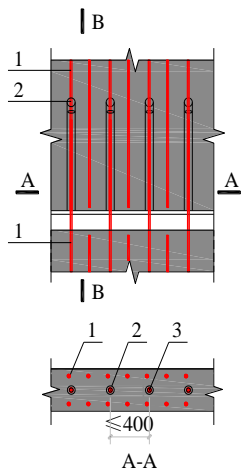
预制剪力墙竖向分布钢筋单排连接构造
